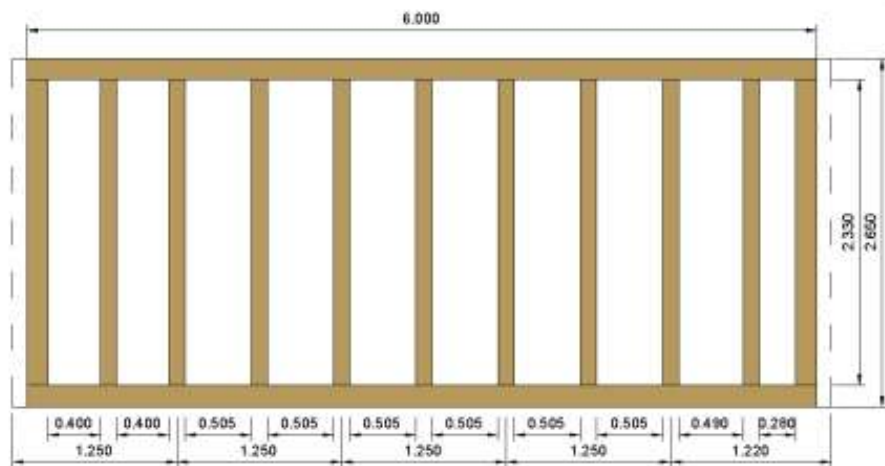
Elemento de parede 1 e 2, constituída por vigas lameladas coladas.
